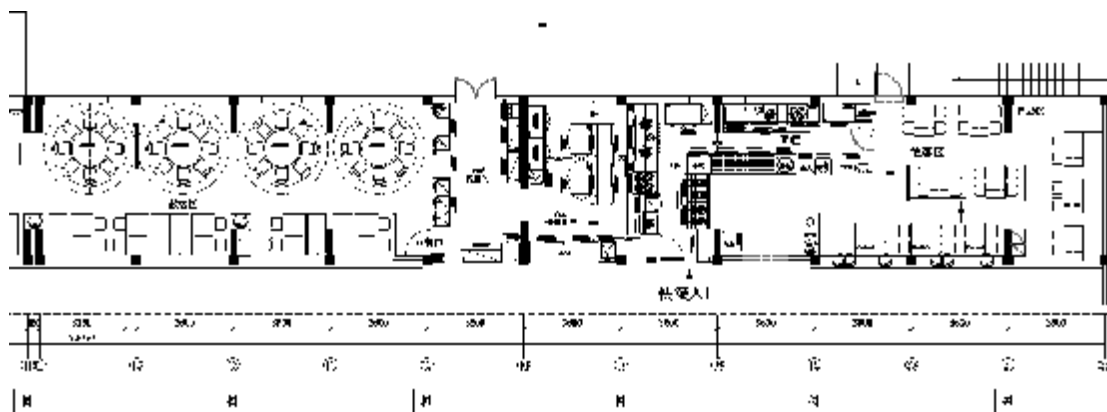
11/1-22 轴拟进行装修改造初步建筑一层平面布置图
